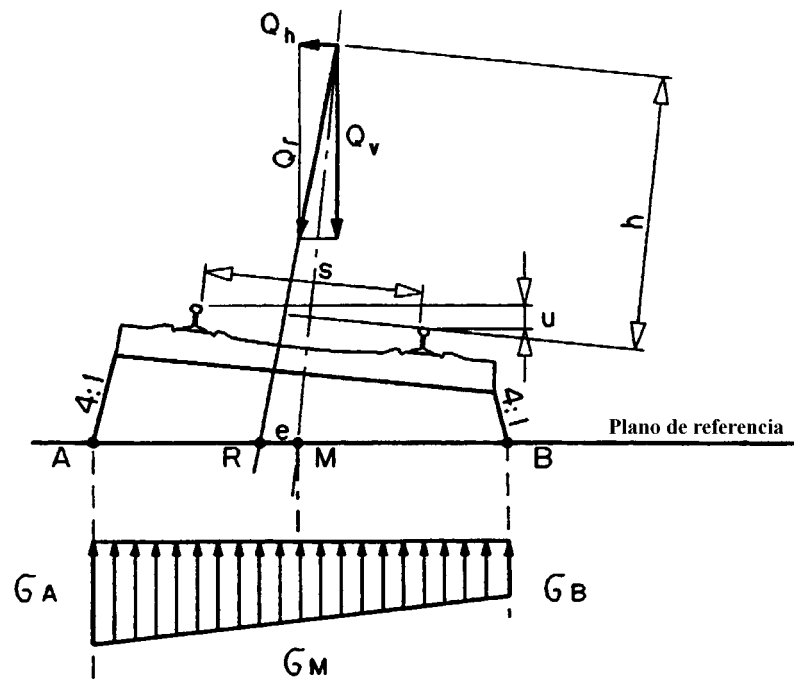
Distribución transversal de las acciones a través de las traviesas y del balasto en vías con peralte
